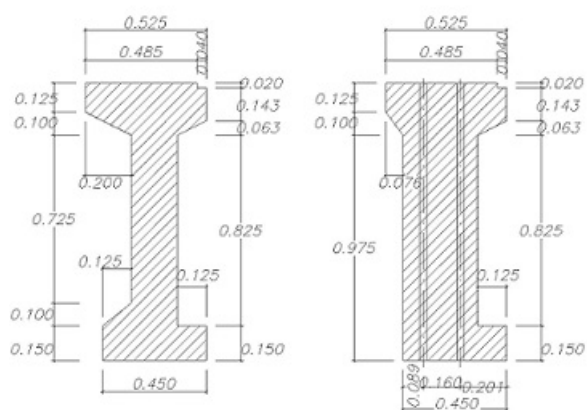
Secção transversal das vigas a meio vão e sobre o pilar [18]
